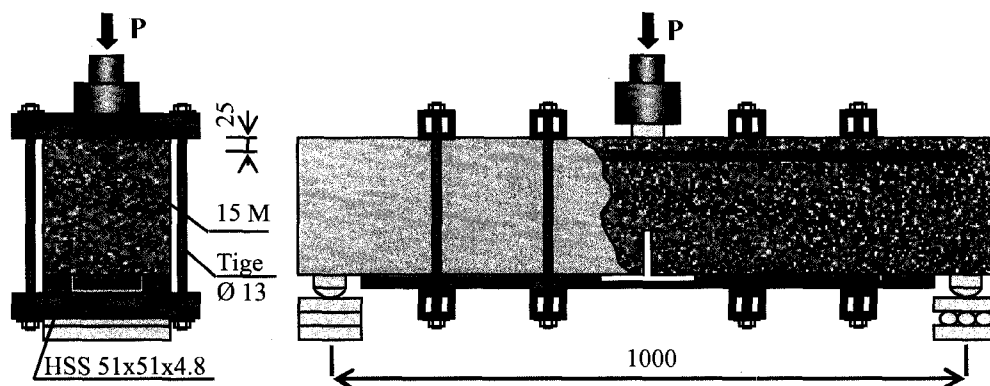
Poutrelles du Groupe B : renforcement en cisaillement @167 mm
